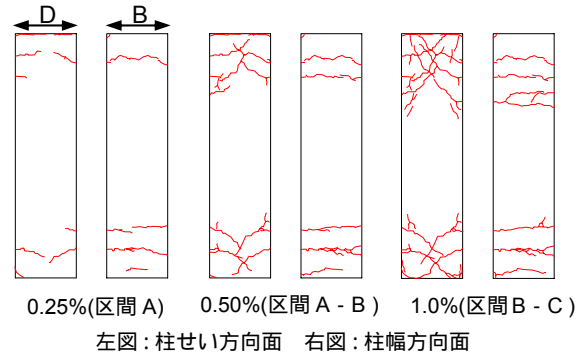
ひび割れ図 (S2-2 試験体)
